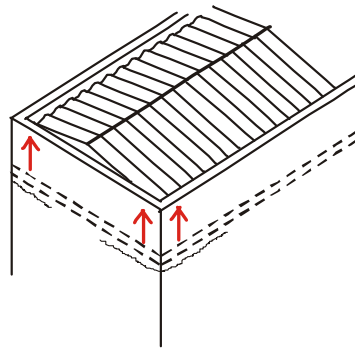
fissura horizontal na interface entre a parede e a laje por deformação da laje de cobertura (DUARTE, 1998)
